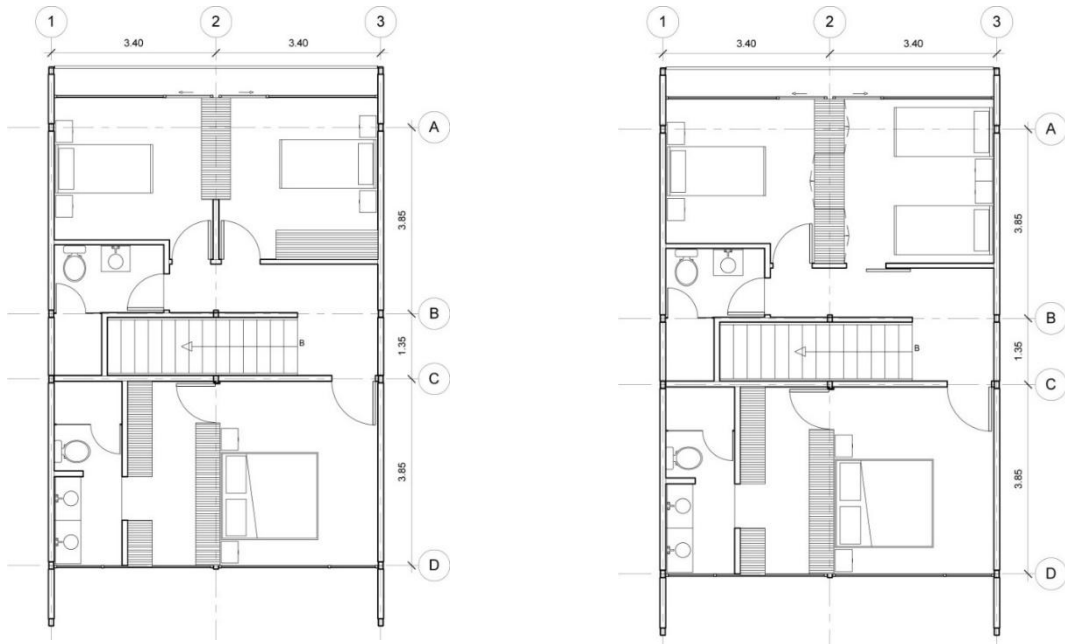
Planta baja (izquierda) y planta alta opción 1 (derecha).
